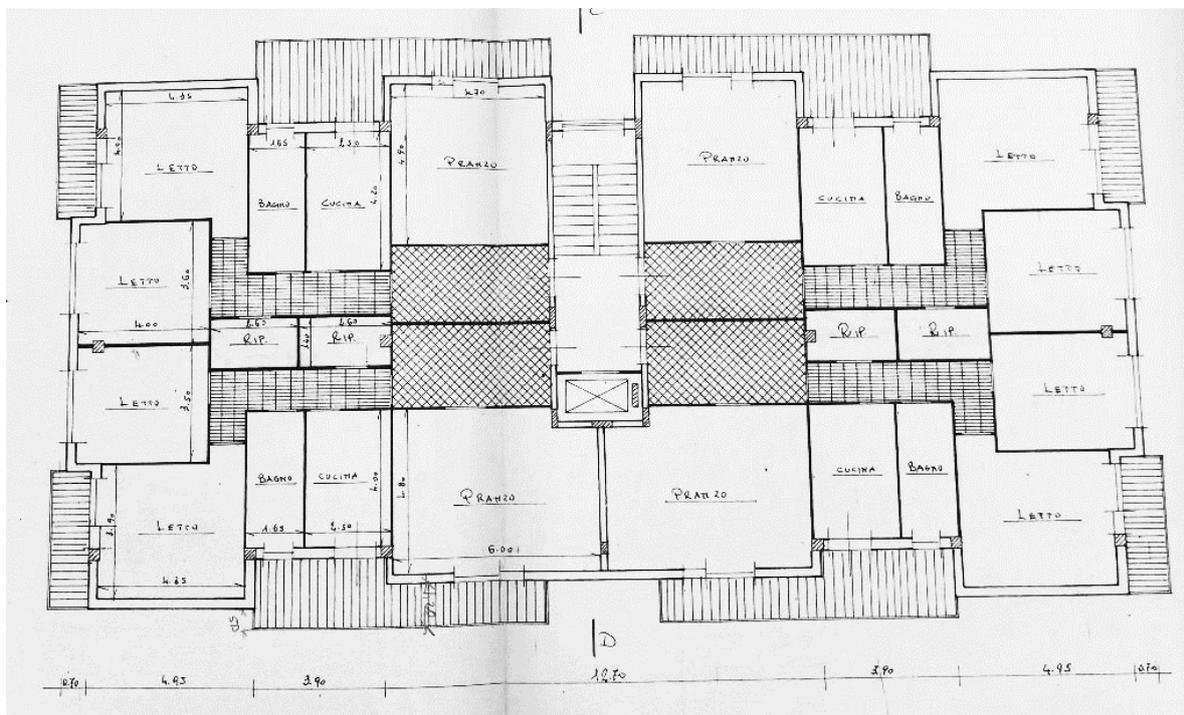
Stralcio del progetto in variante prot. 180 del 14/04/1969 con planimetria del piano tipo
